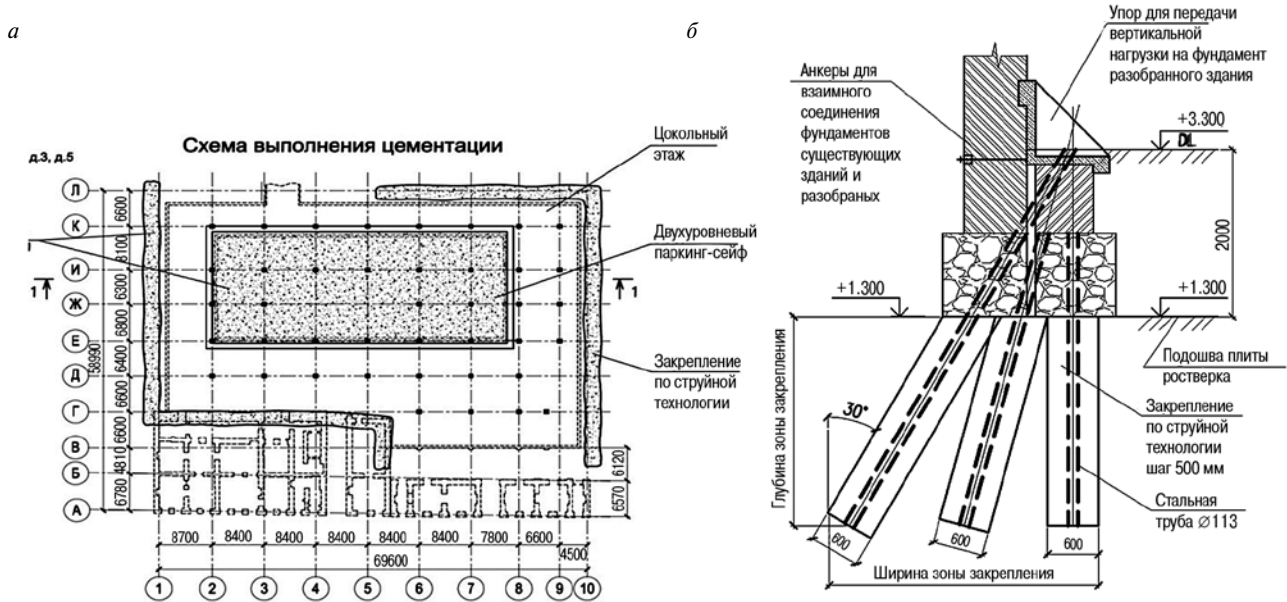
Схема усиления грунта под подошвой фундаментов окружающих зданий с помощью технологии JetGrouting: а – план; б – характерный разрез
